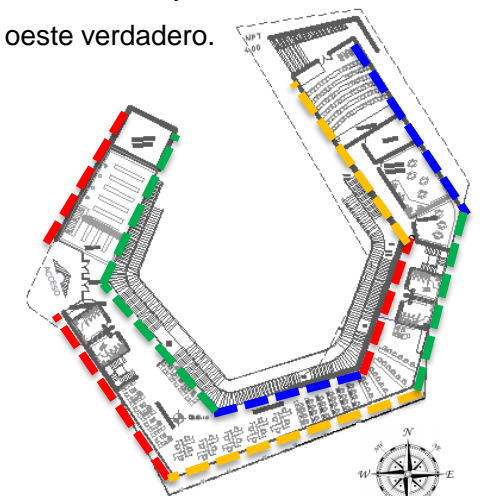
Imagen CI . Planta Arquitectónica biblioteca (ACS, 2013)
